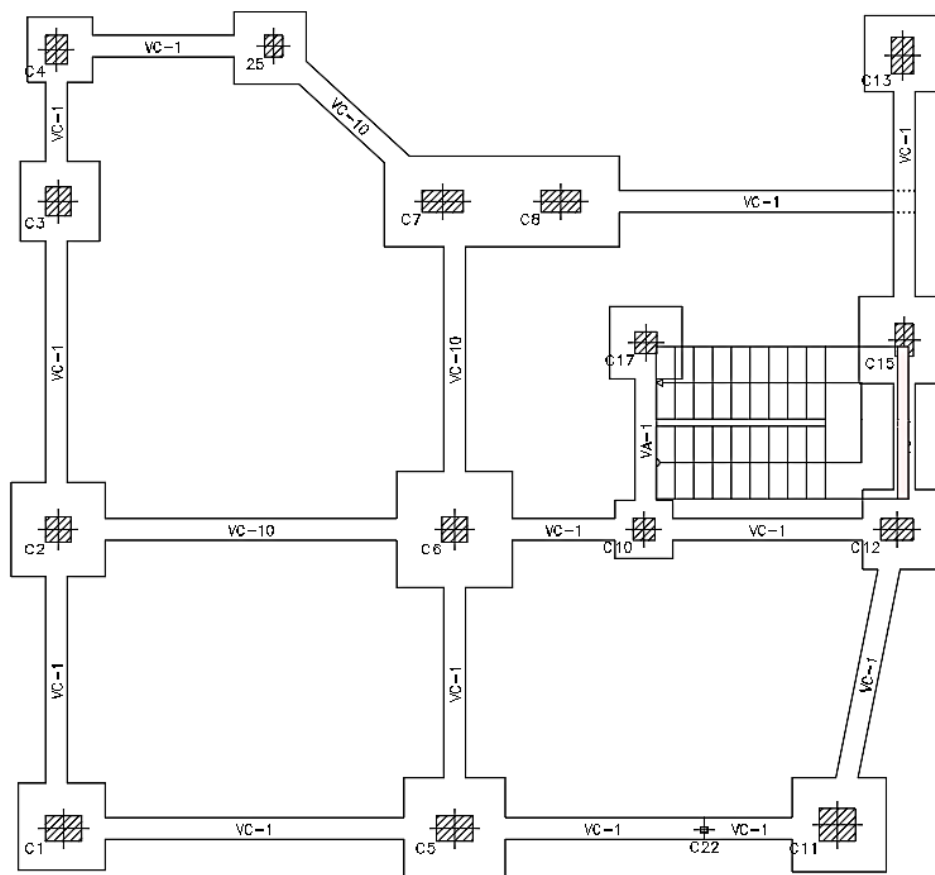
Detalle de zapatas – zapata corrida “C7 – C8”.
